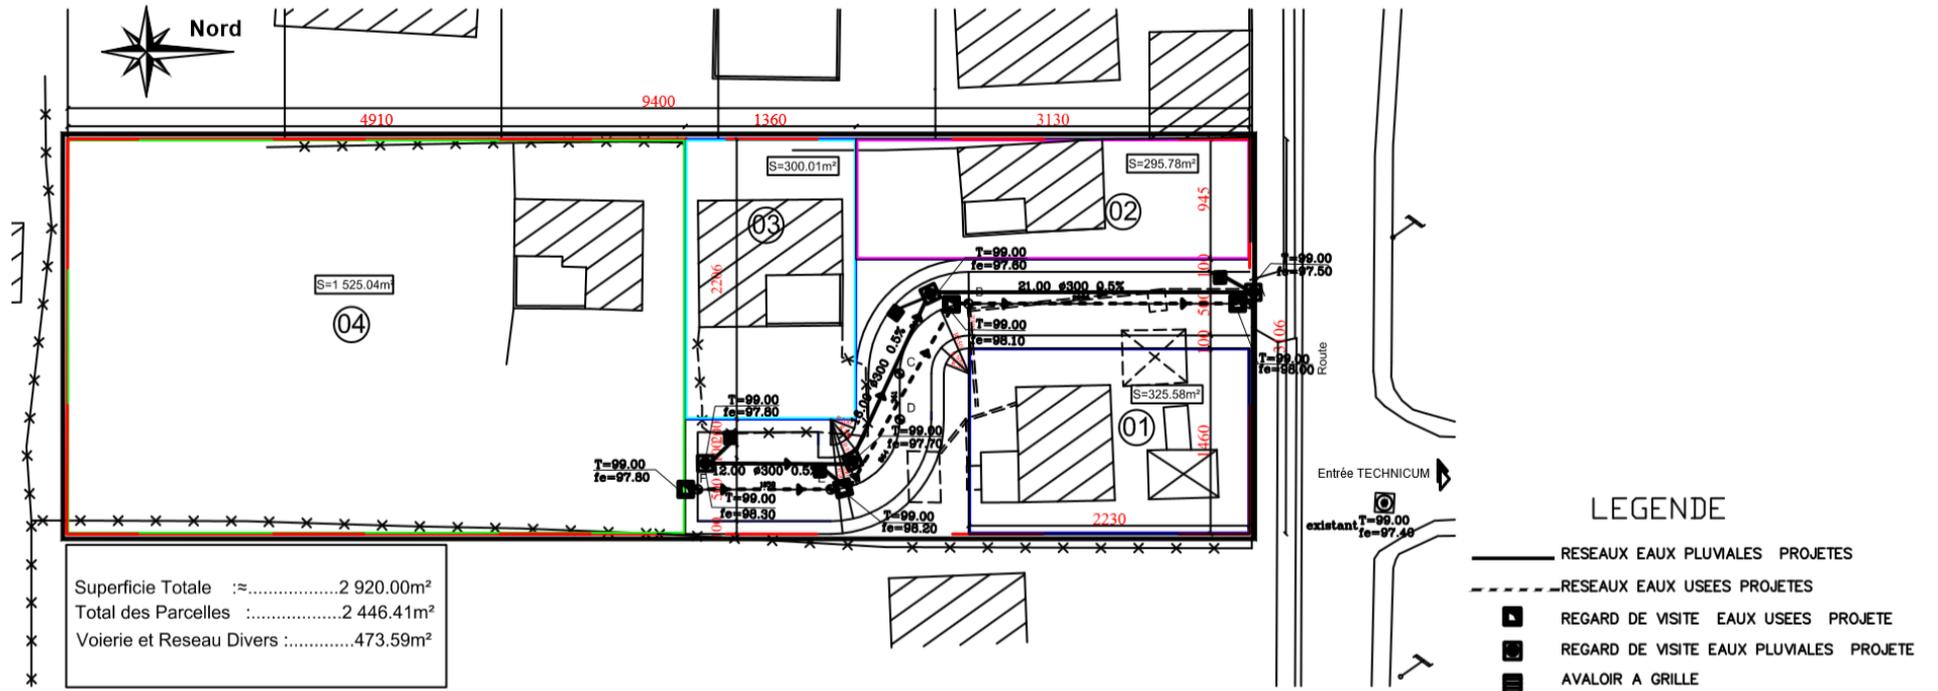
Exemple 1 PLAN ASSAINISSEMENT & EAUX PLUVIALES Ech:1/200e
